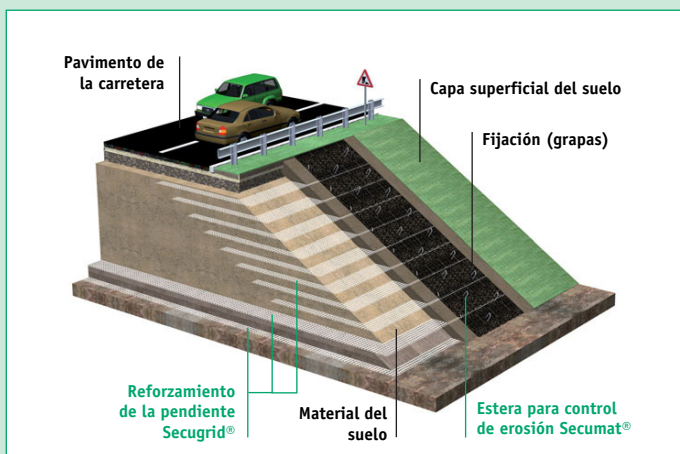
Pendiente reforzada con Secugrid® con una inclinación de 45°.
